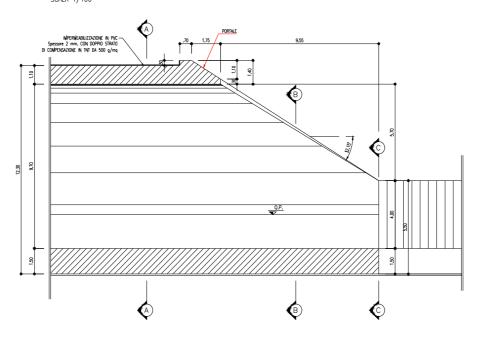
sezione tipo di imbocco PE lato caltanissetta
